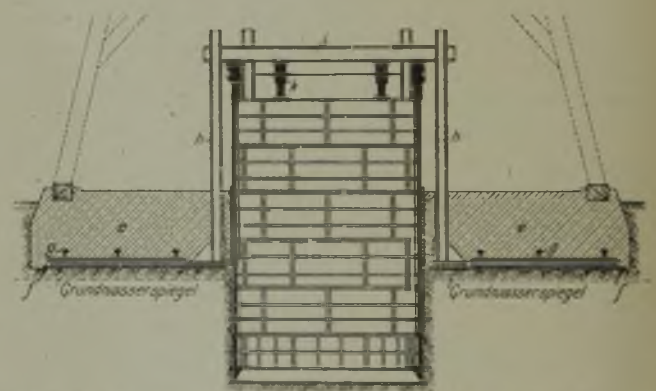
Pressenwiderlager aus Beton mit breiter Grundfläche.
